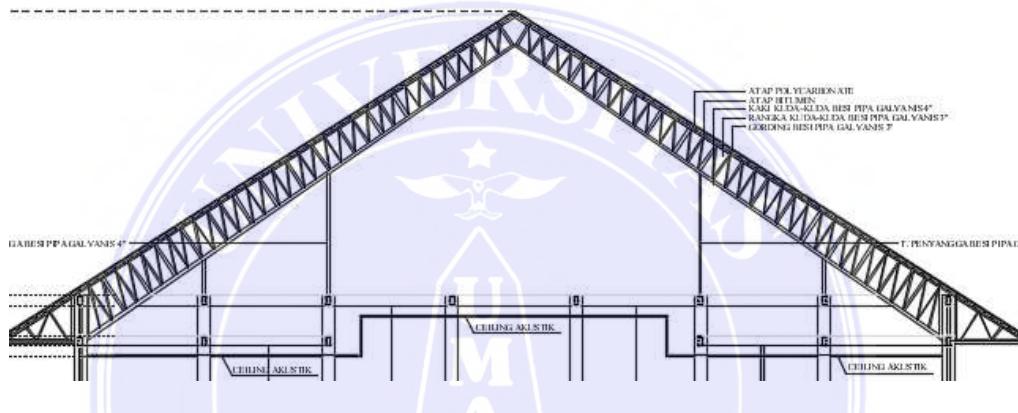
Konsep struktur balok dan kolom bangunan.
